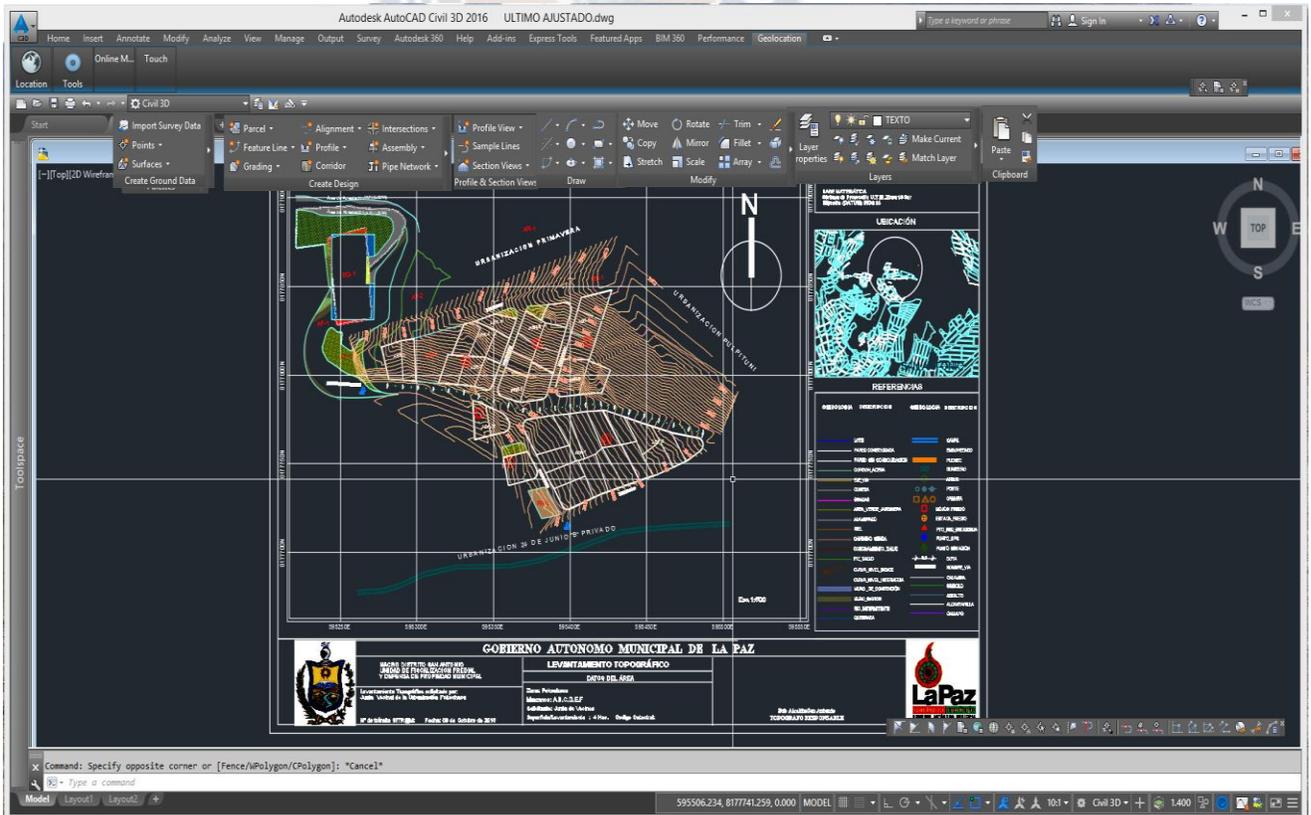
Plano topográfico del sistema de alcantarillado de la Urbanización Pokechaca.
